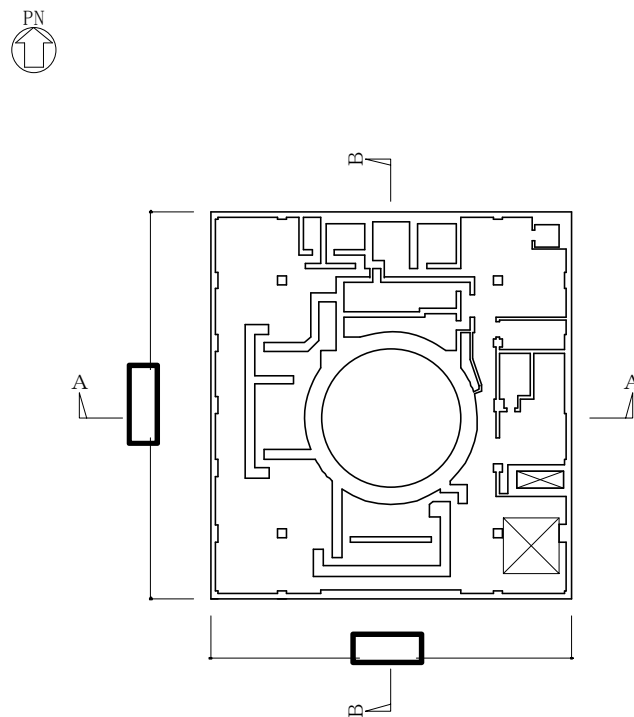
(6/9) の概略平面図 (EL. 29.0 m)
